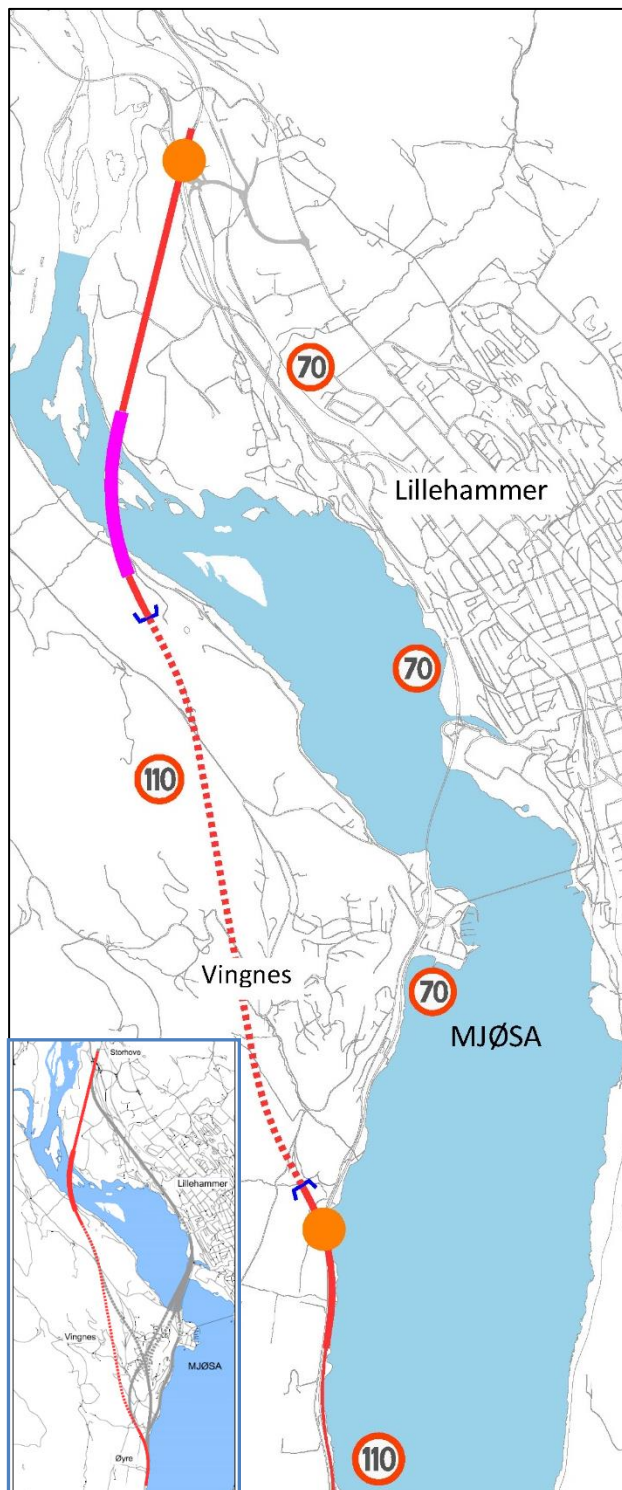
Plan for ny bru over Lågen for vestre alternativ.
